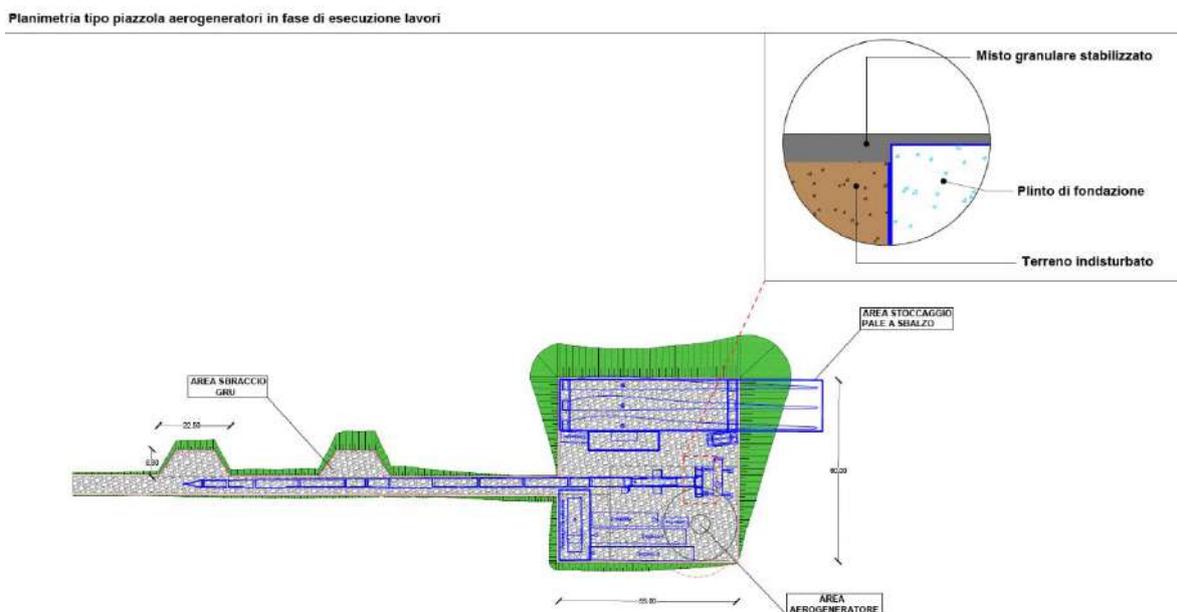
Planimetria piazzola tipo in fase di esecuzione lavori
